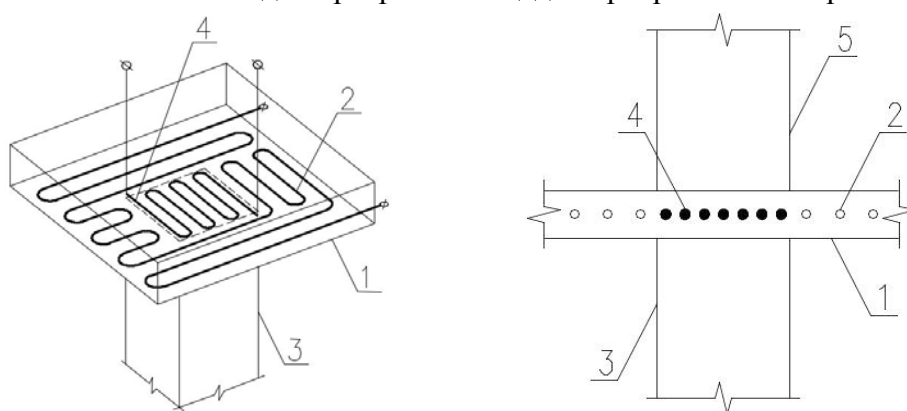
Устройство для электропрогрева стыка колонн и перекрытия: *1* – плита перекрытия, *2* – нагревательный элемент на всю площадь перекрытия, исключая площадь колонны, *3* – нижняя колонна, *4* – нагревательный элемент на площадь колонны, *5* – верхняя колонна
